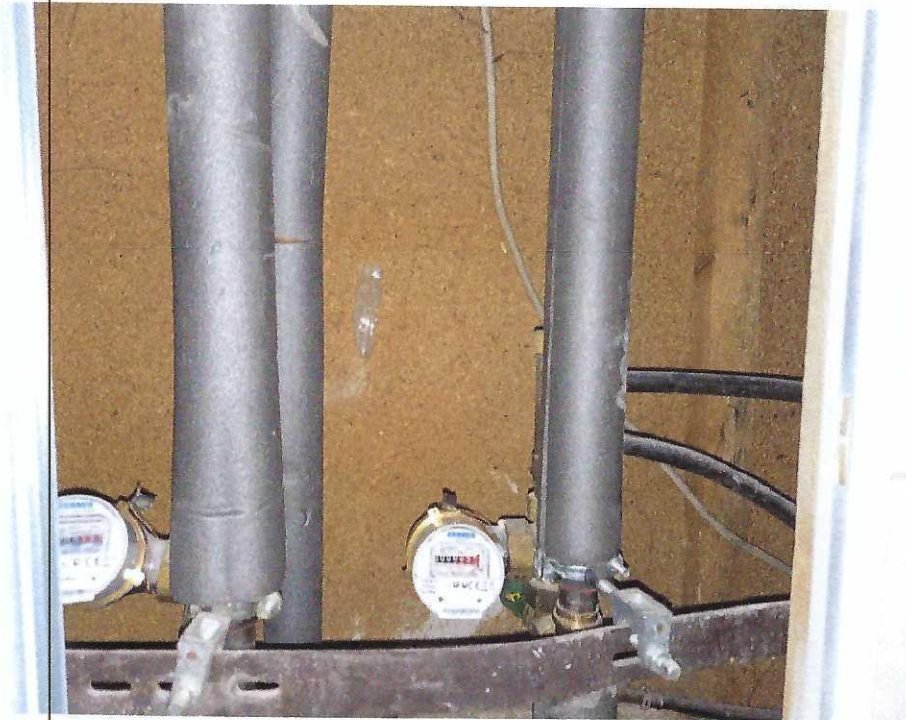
Pressspanplatten im Installationsschacht Küche / Bad
